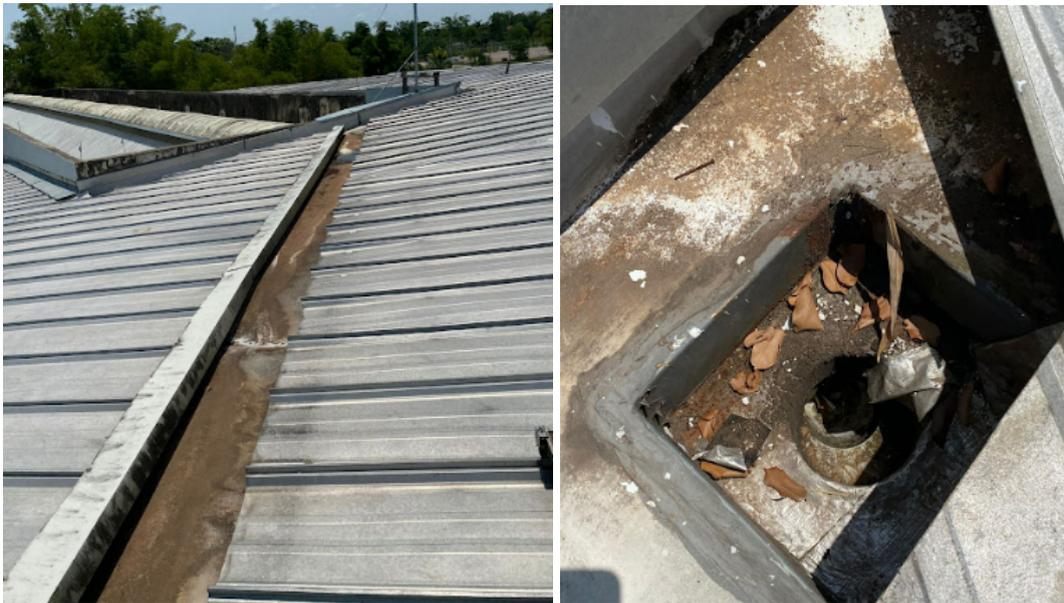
Conjunto de calha e tubo de queda do sistema de drenagem.
